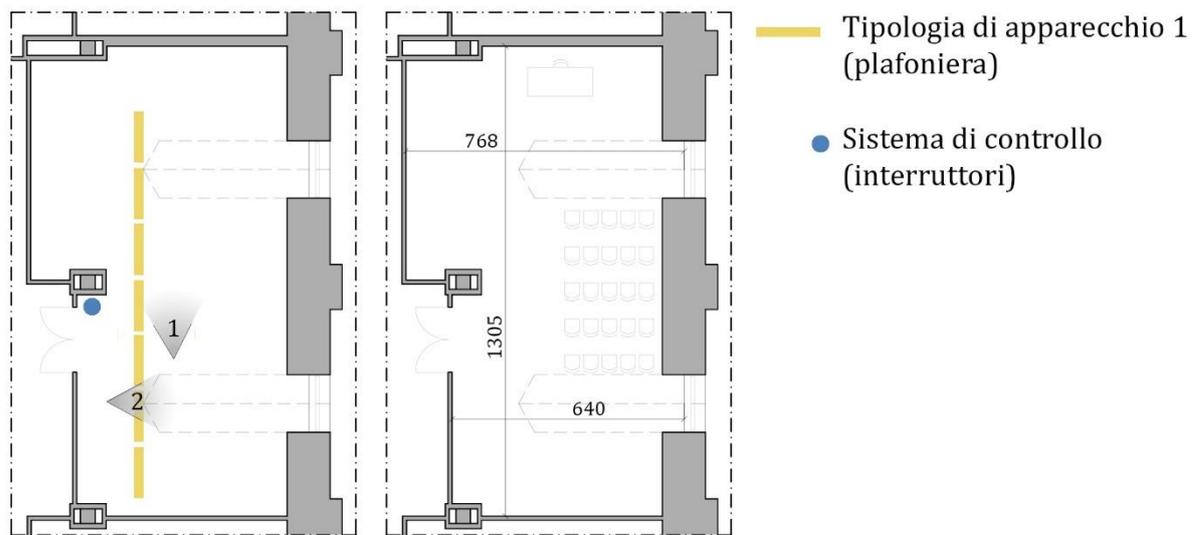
Pianta in scala 1:200 con posizione degli apparecchi e degli interruttori, con ottico delle foto, posizione dei banchi e quote della sala conferenze, situata a sud-ovest del secondo piano.
